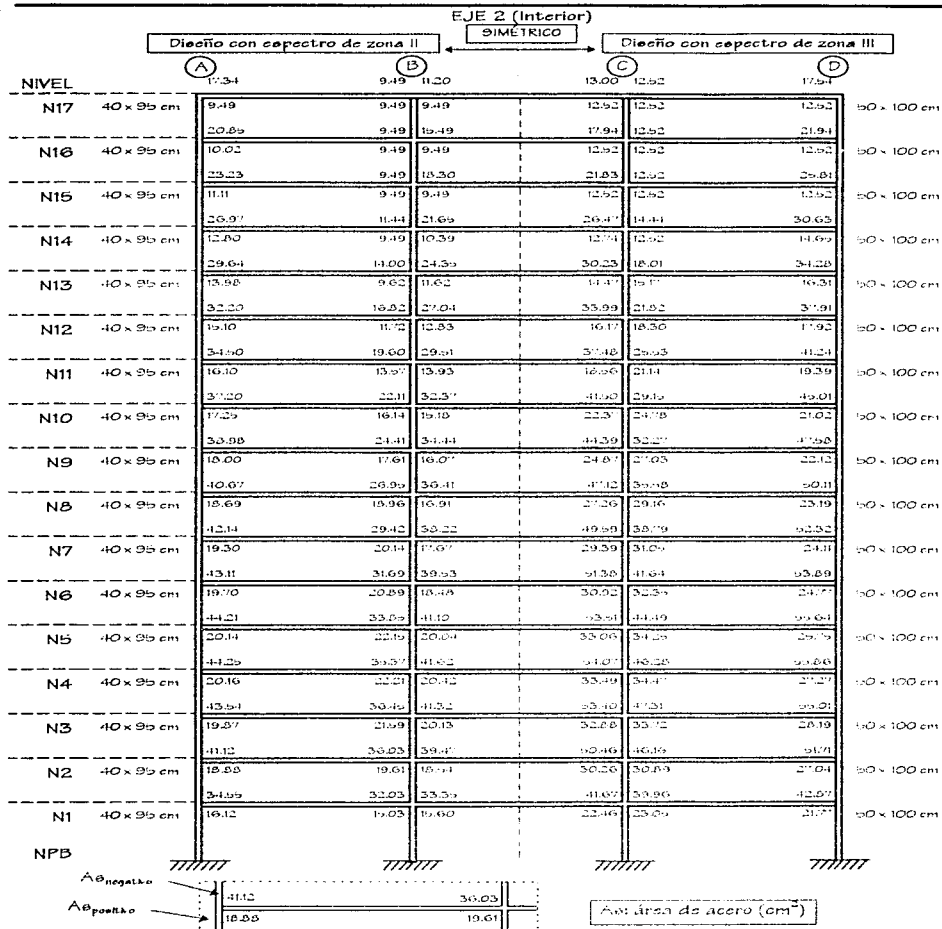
Comparación de cuantías de acero de refuerzo longitudinal de las vigas del eje 2 de las estructuras diseñadas en las zonas II y III
